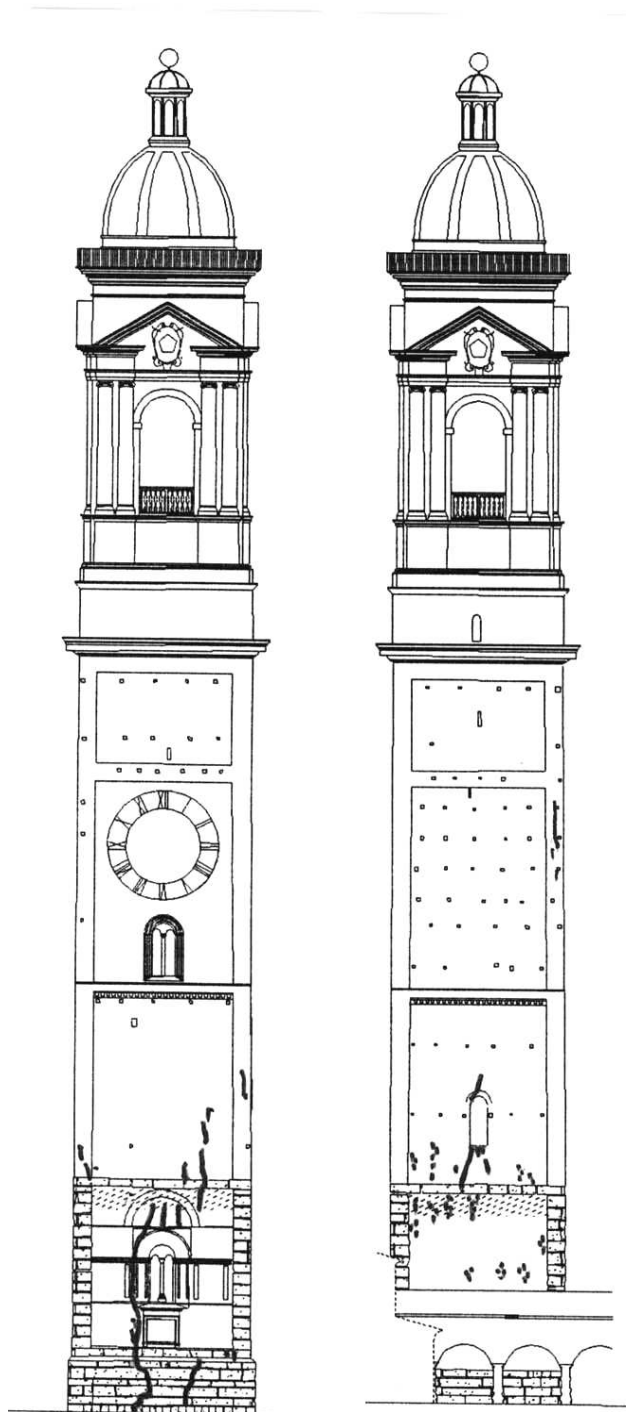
Rilievo del quadro fessurativo effettuato sui prospetti di due lati opposti di un campanile
